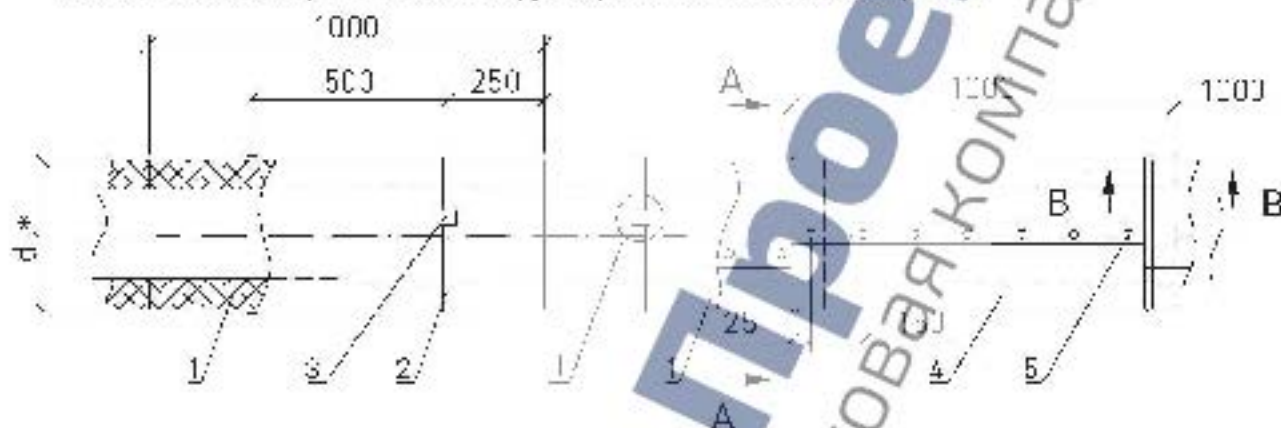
Тепловая изоляция горизонтальных трубопроводов
